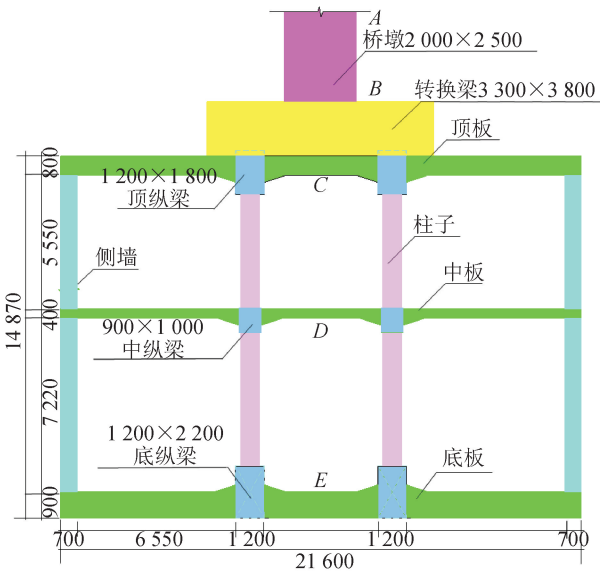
地铁车站与城市桥梁合建体的横断面示意图(单位:mm)
